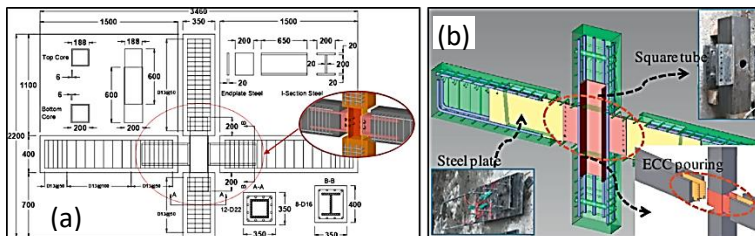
Nudo híbrido apropiado para ampliaciones de edificaciones de HA con estructuras de acero. (a) Pórtico ensayado. (b) Aplicación de cargas durante el ensayo. (Ugel, 2015).
